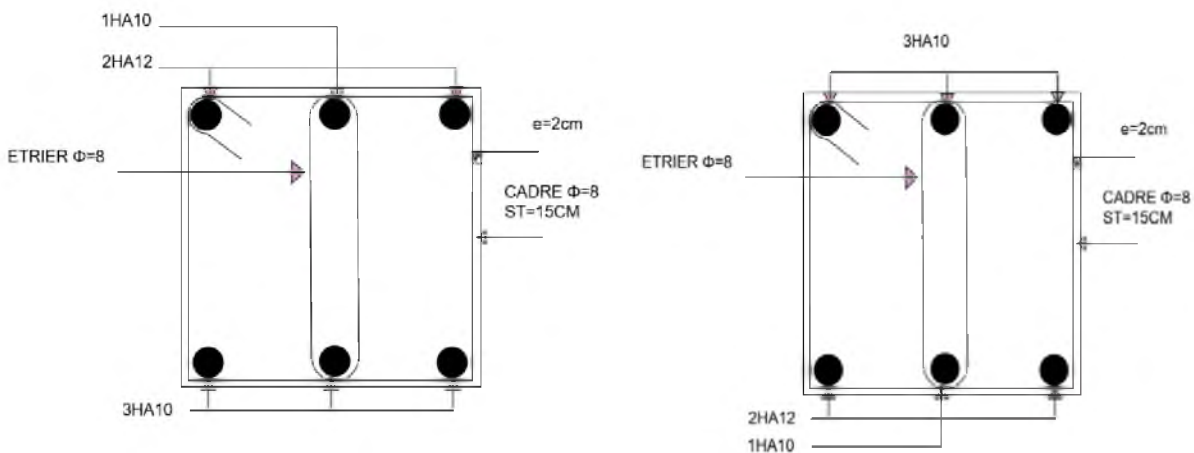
Schéma de ferrailage de la poutre de chaînage
